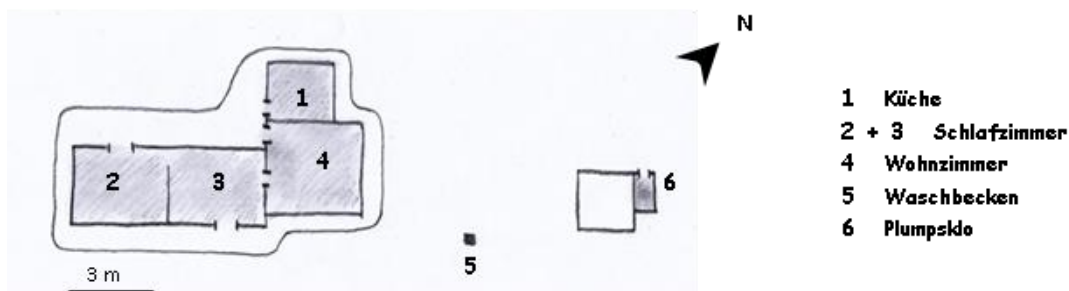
Grundriss des Wohnbereiches der Finca *El Jazmín*.
